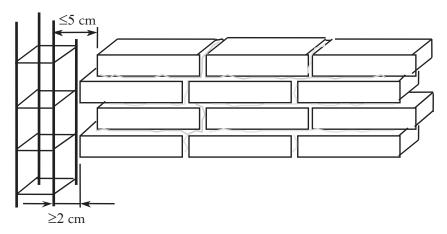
Distancias mínimas al pilar en albañilería reforzada.
